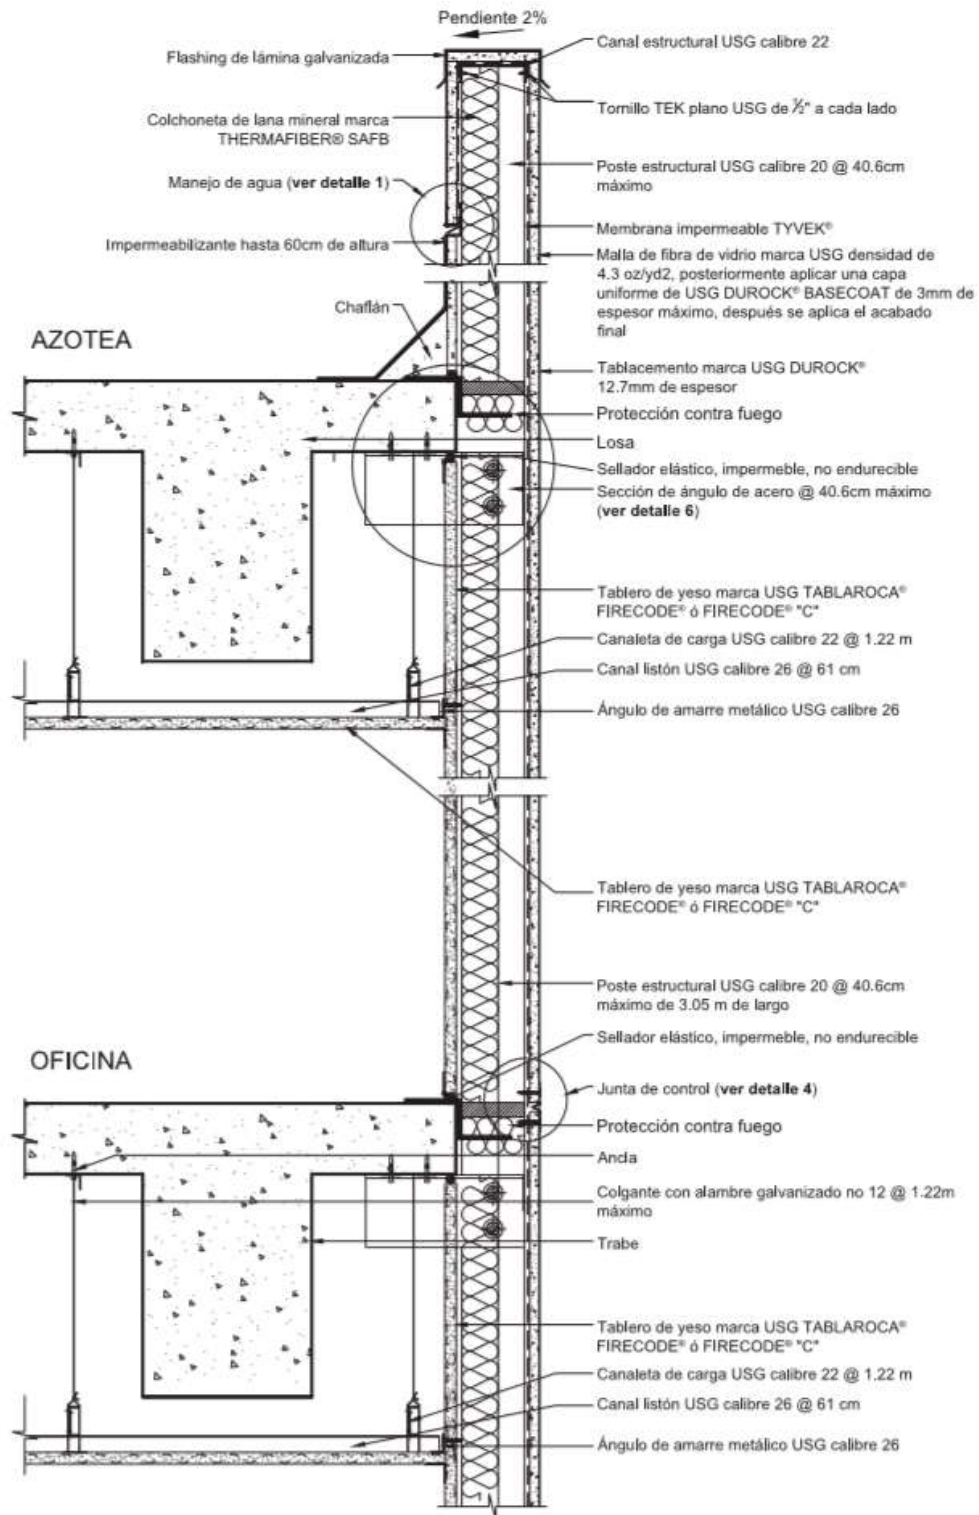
Instalación tipo Muro Cortina - USG, 2016.
